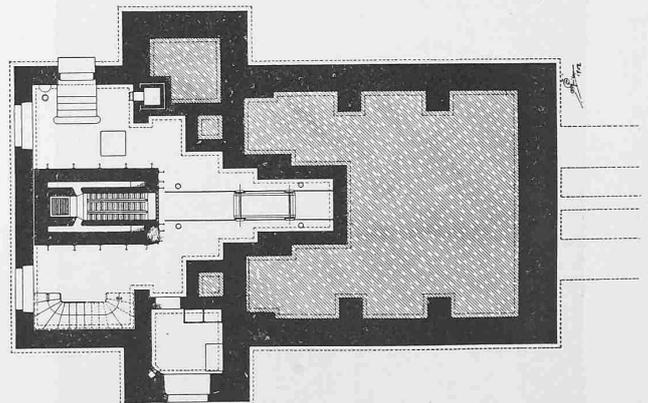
Grundriss vom Untergeschoss. — Masstab 1:250.
